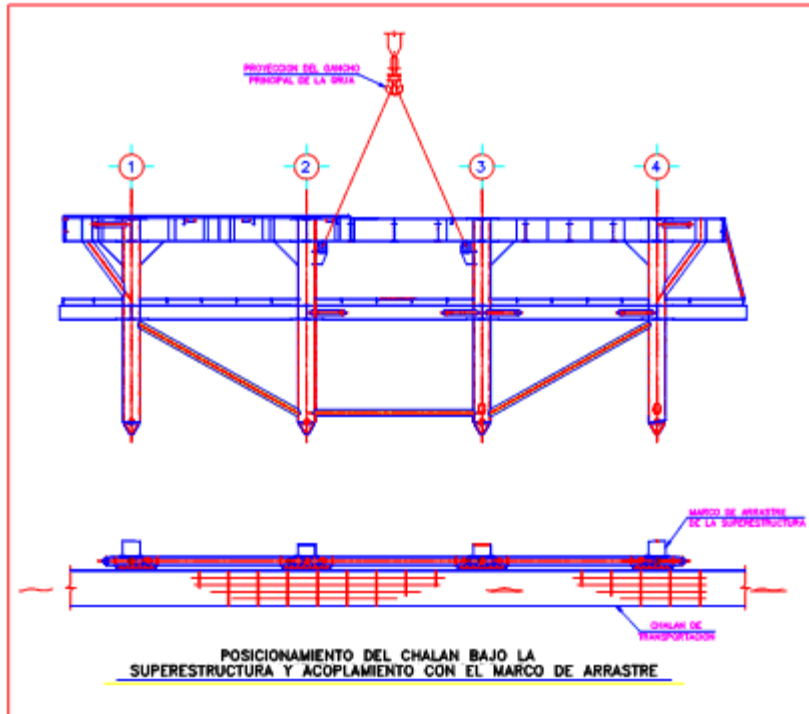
IZAJE Y COLOCACIÓN EN EL CHALÁN DE TRANSPORTE
